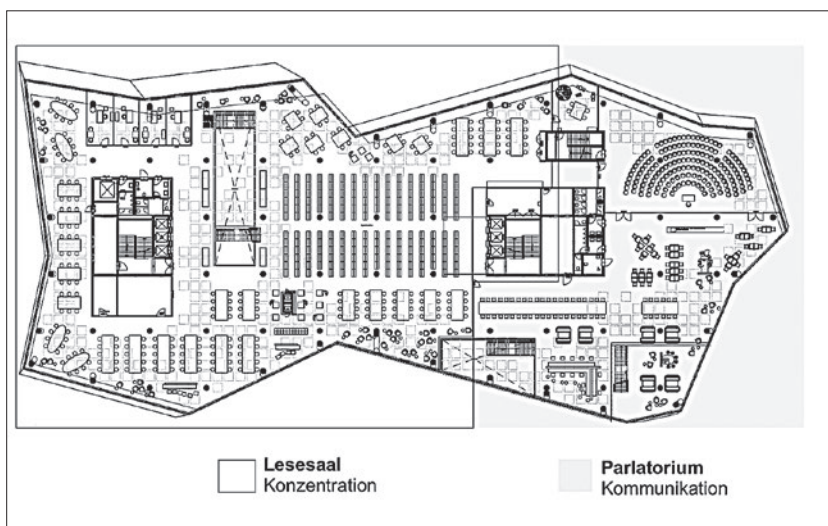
Grundriss des 1. Obergeschosses mit Veranstaltungs- und Eltern-Kind-Raum
